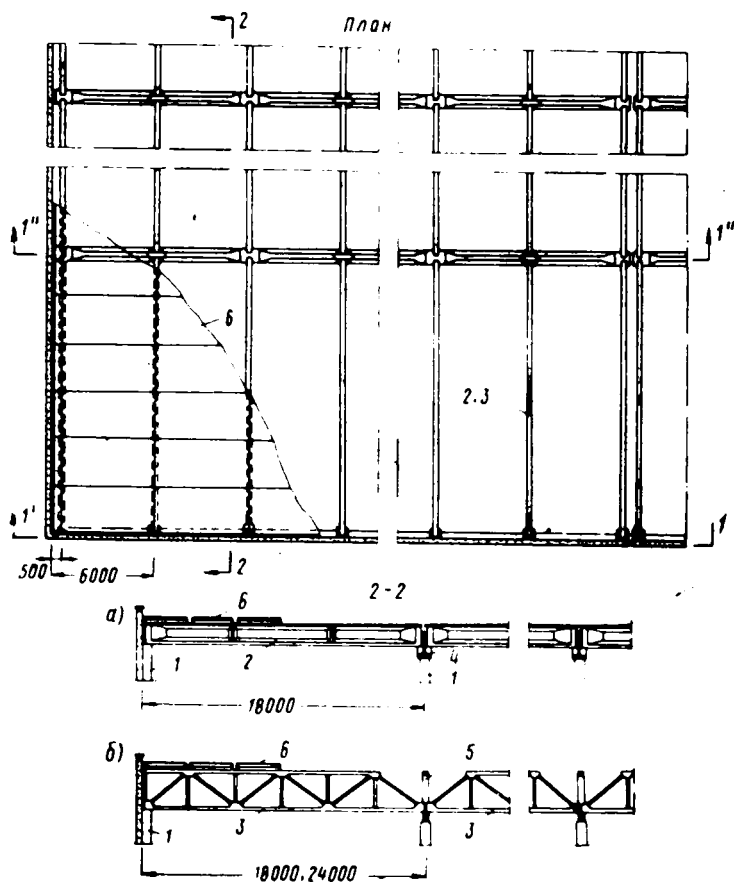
Конструктивная схема IV (разрез 1'-1' аналогичен 1-1 на рис. 2.5; 1''-1'' аналогичен 1-1 на рис. 2.7; обозначения по рис. 2.5 и 2.7)
